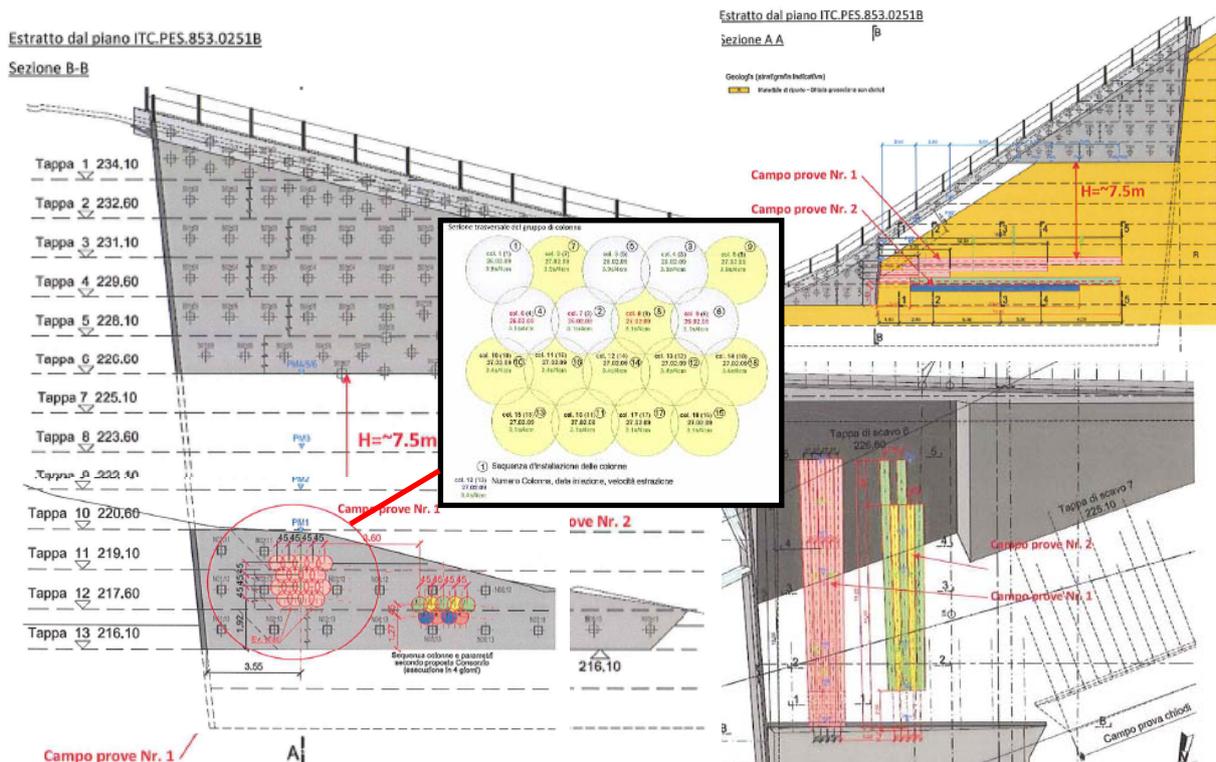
Ausschnitt Projekt Probefeld Horizontaljetting
